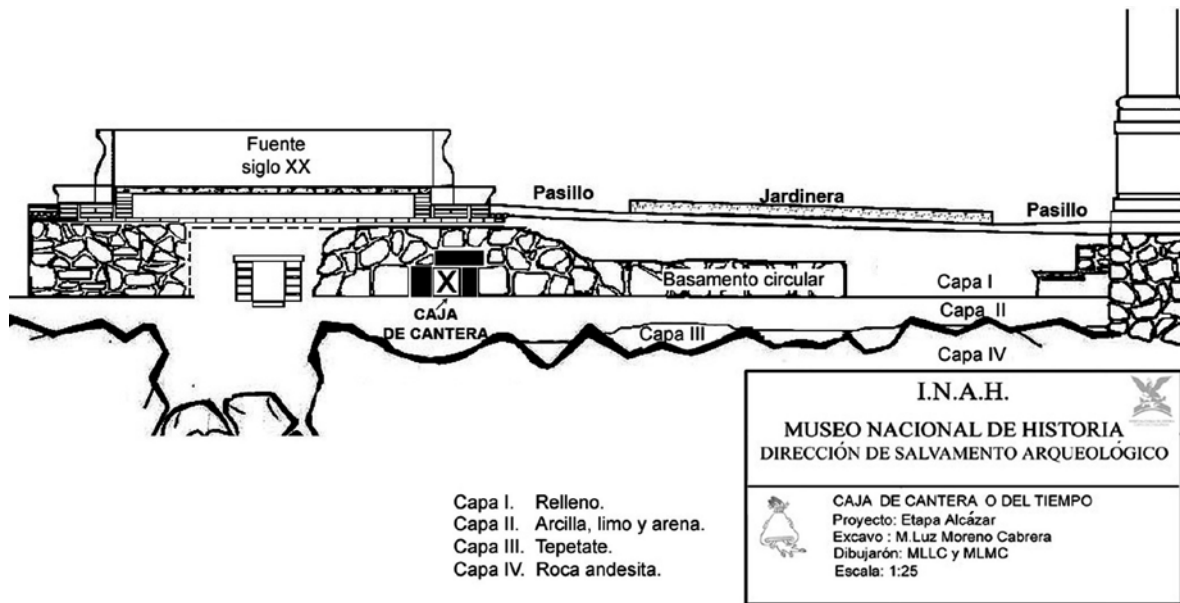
Plano B. Ubicación de caja de cantera en el área del Alcázar.
